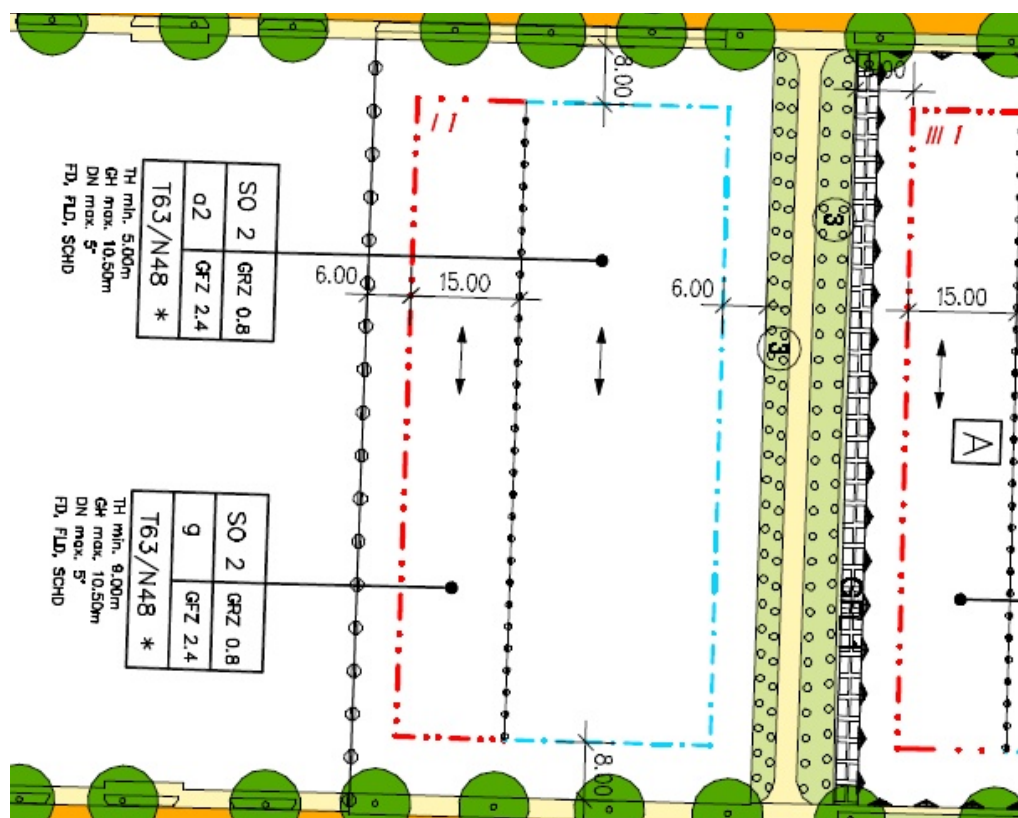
Ausschnitt aus rechtskräftigem Bebauungsplan „D9-Änderung“, Gewerbepark ‚Am Messegelände‘, freier Maßstab
